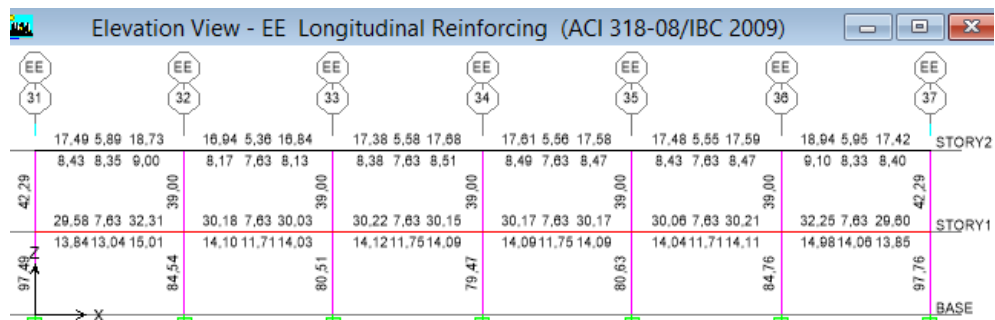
Acero en Vigas y Columnas en el Pórtico EE – Obstetricia - (NEC-11)
